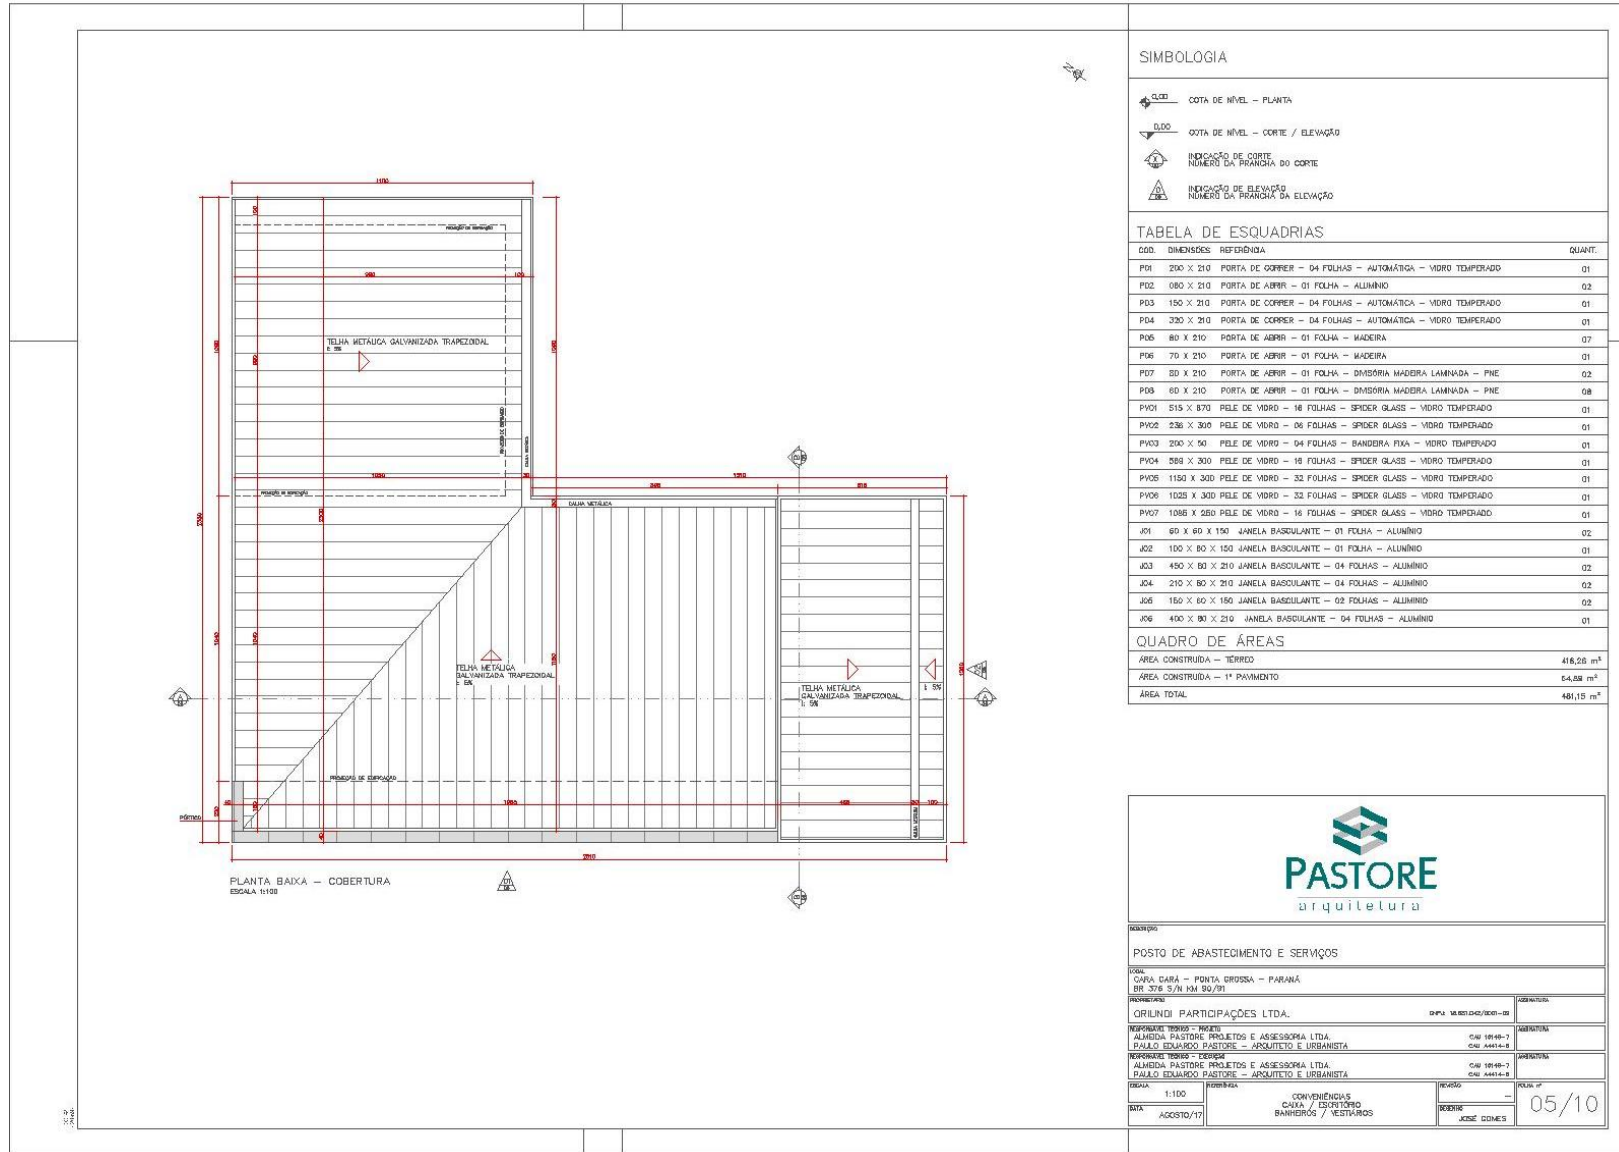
Planta baixa: conveniências, caixas, escritório, banheiros e vestiários.
